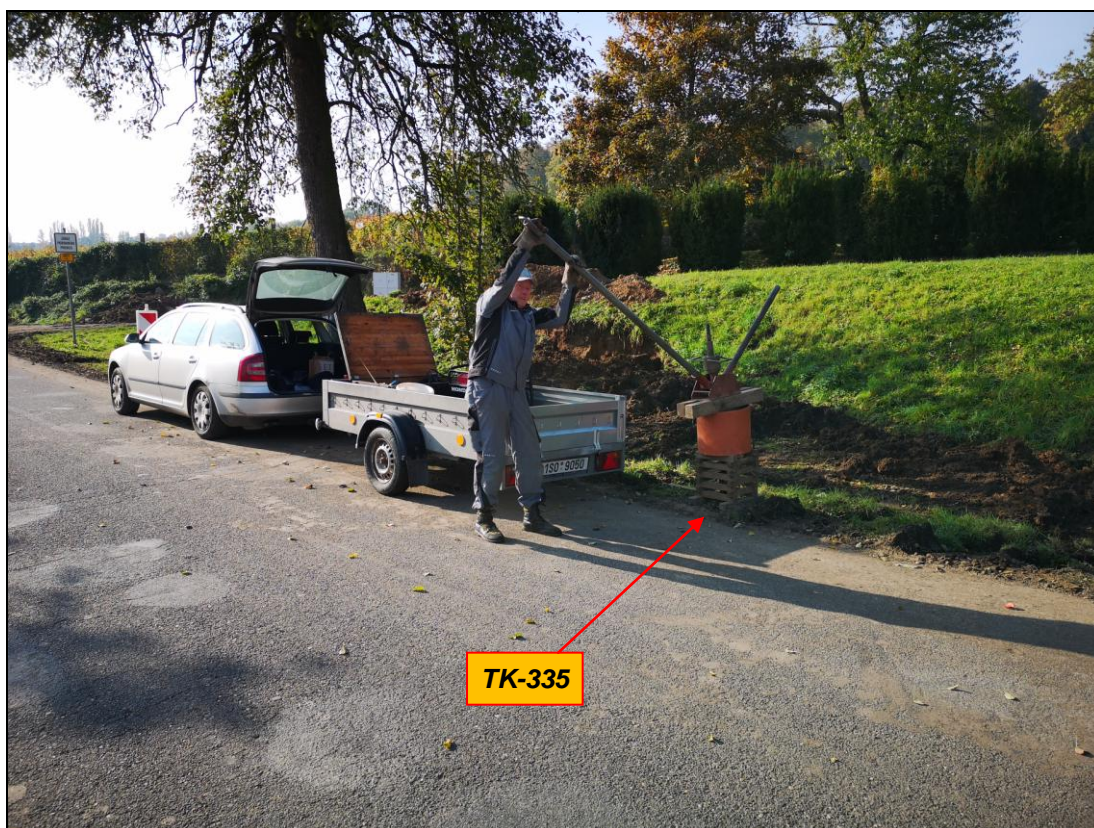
Hloubení průzkumné jádrové sondy TK-335 elektrickou sondážní soupravou WACKER EH 230/23 + vytahování sondážního soutyči pákovým adaptérem (konečná hloubka sondy 1,00 m, průměr jádra 80 mm – foto 20.10. 2020)
